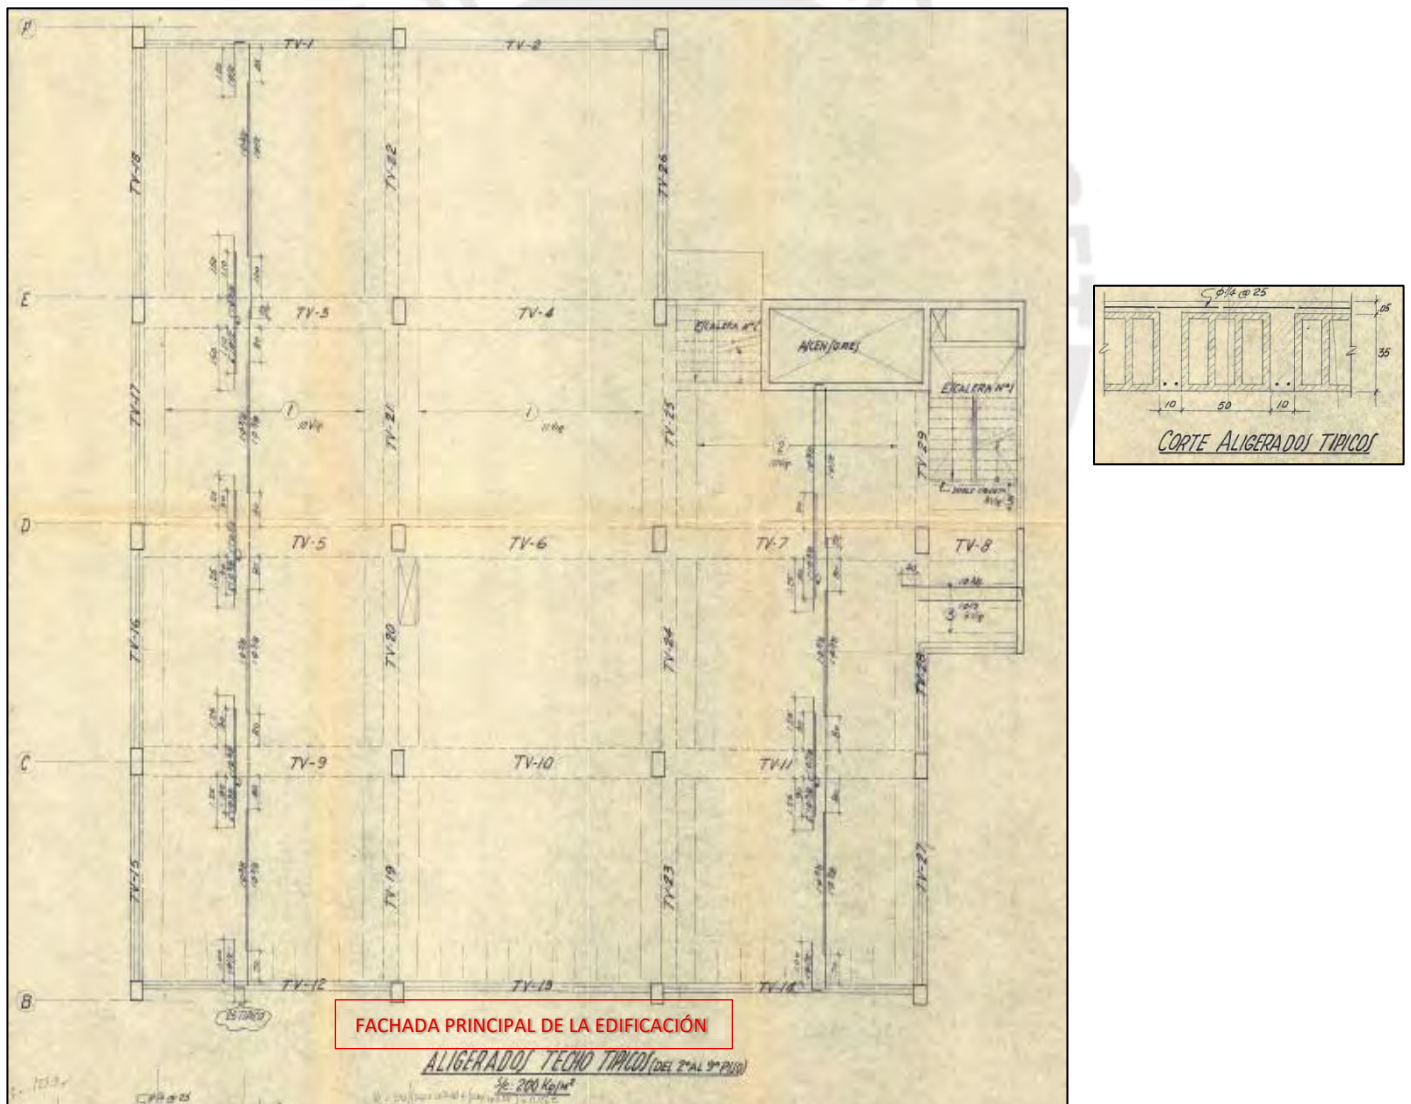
Planta Típica del Edificio empleado en el Estudio.
